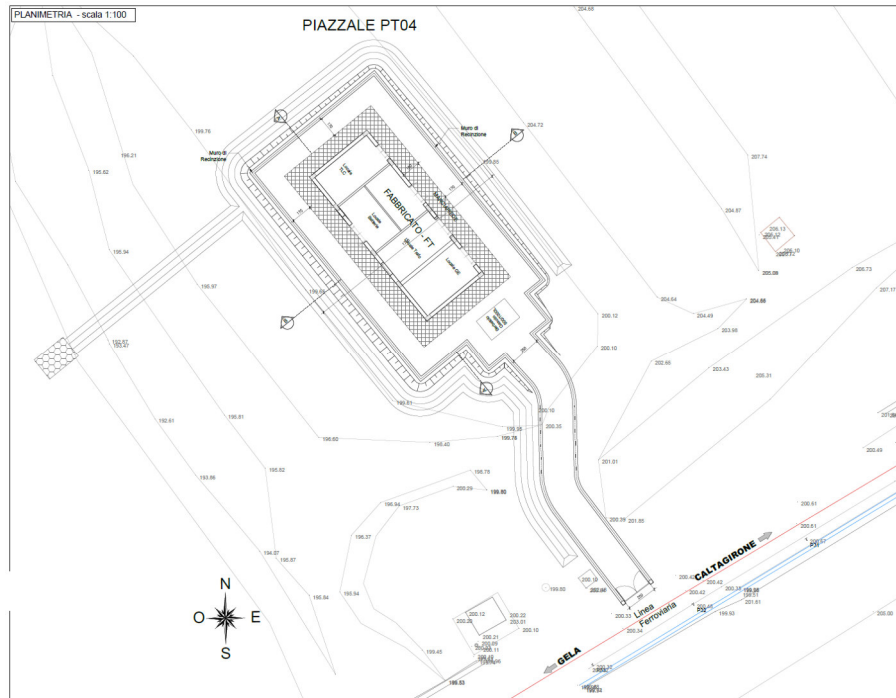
PT04 Planimetria piazzale GA dell'Arcia imbocco sud
